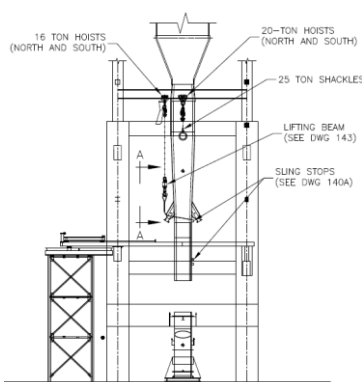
Ingeniería de rigging conceptual izaje riser externo.
